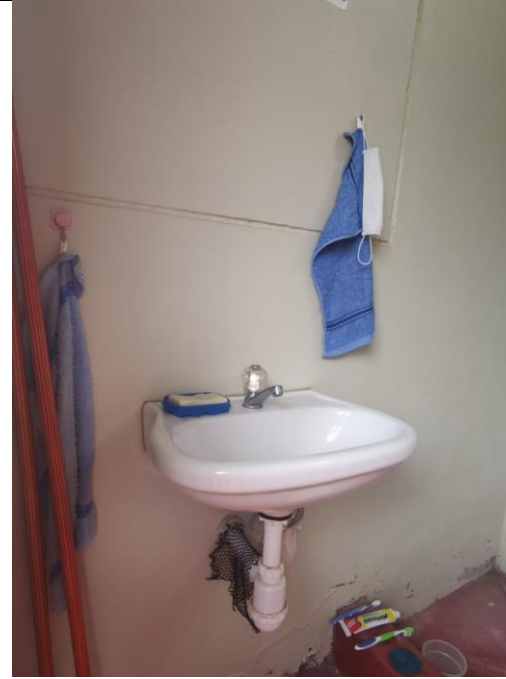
Beneficiarios con proyecto – se observa el lavadero de manos
